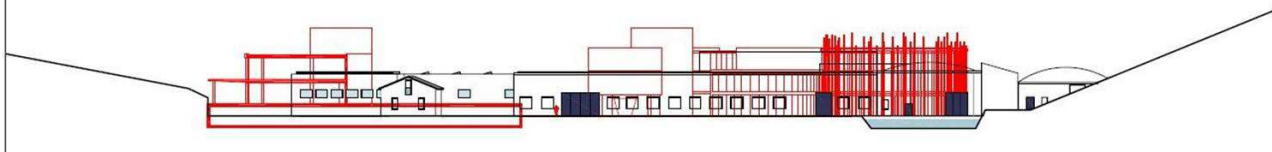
Stralci dell’elaborato di progetto Tav. 3.3 Progetto – Raffronto – planimetrie, profili regolatori, dimensioni
